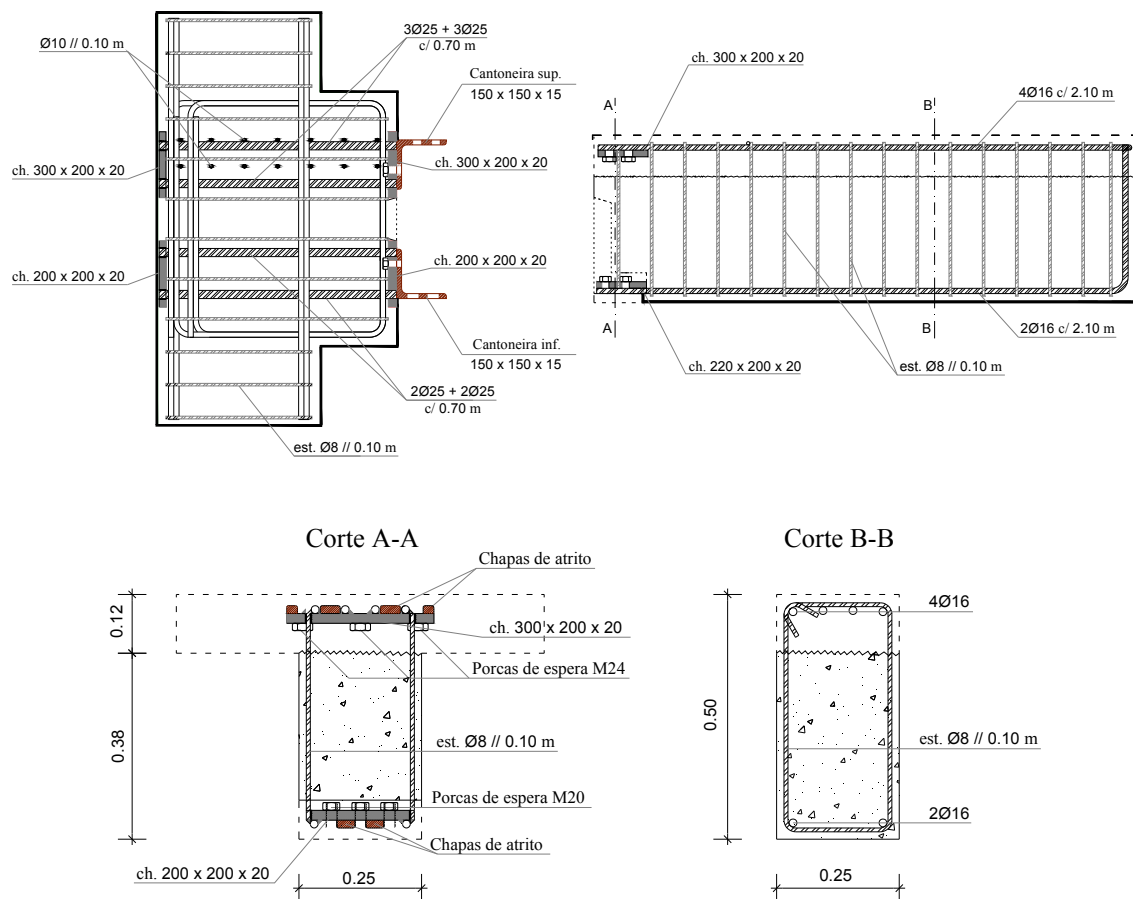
Pormenorização das armaduras e disposição dos elementos de ligação do modelo pré-fabricado
